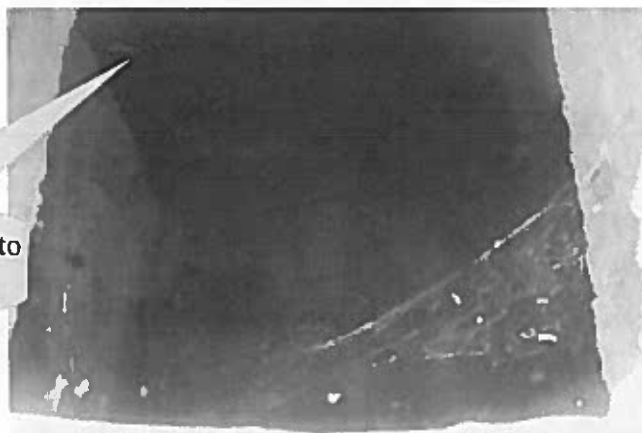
particolare della canalizzazione di via Baccarini , sulla sinistra lo sbocco della canalizzazione di collegamento con la caditoia delle foto 11-12; foto scattata da apertura con griglia ubicata nello slargo di via Baccarini (vedasi foto 11).
